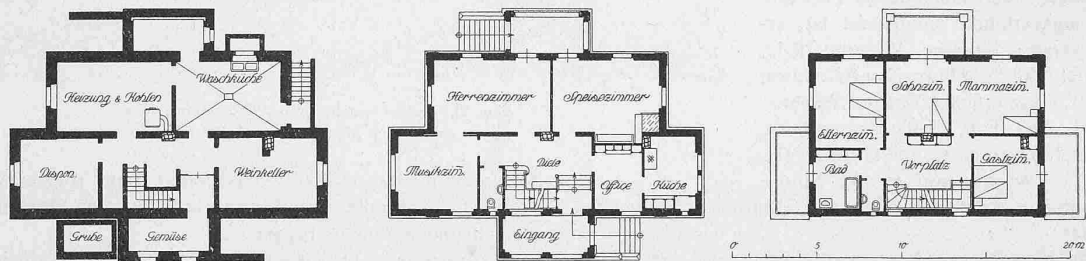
bis 3. Grundrisse vom Landhaus P. Naef-Werner in Küsnacht am Zürichsee. — Masstab 1:400.
